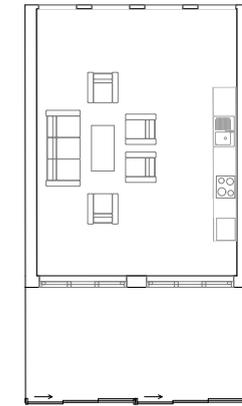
Standardwohnung Grundrissvarianten
